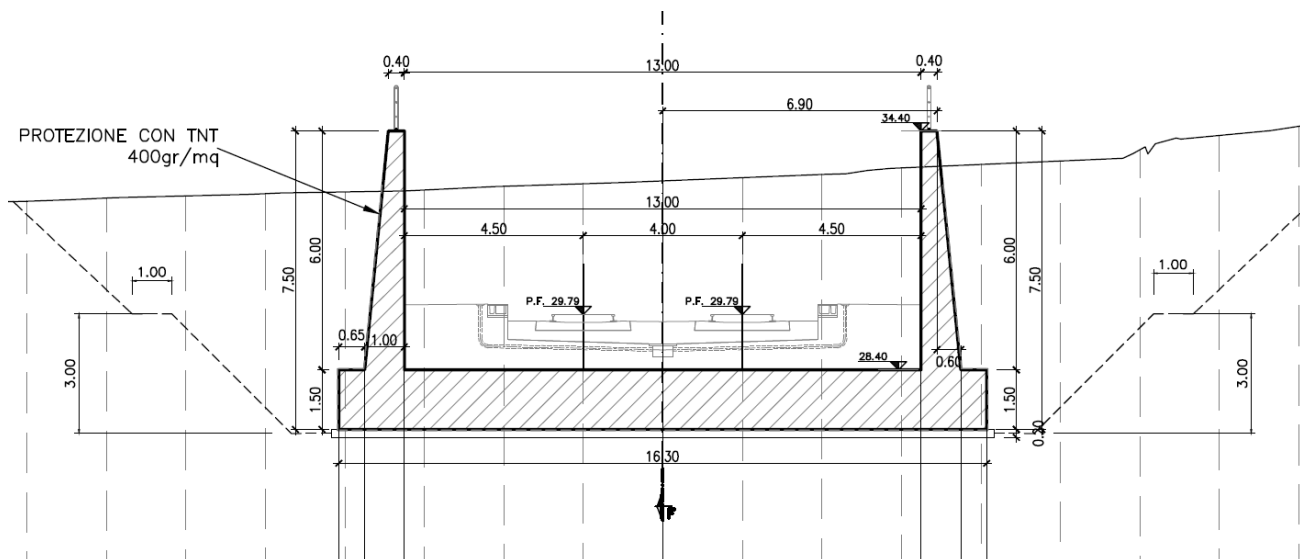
Sezione muro di imbocco (Hmin=6.00 m)
